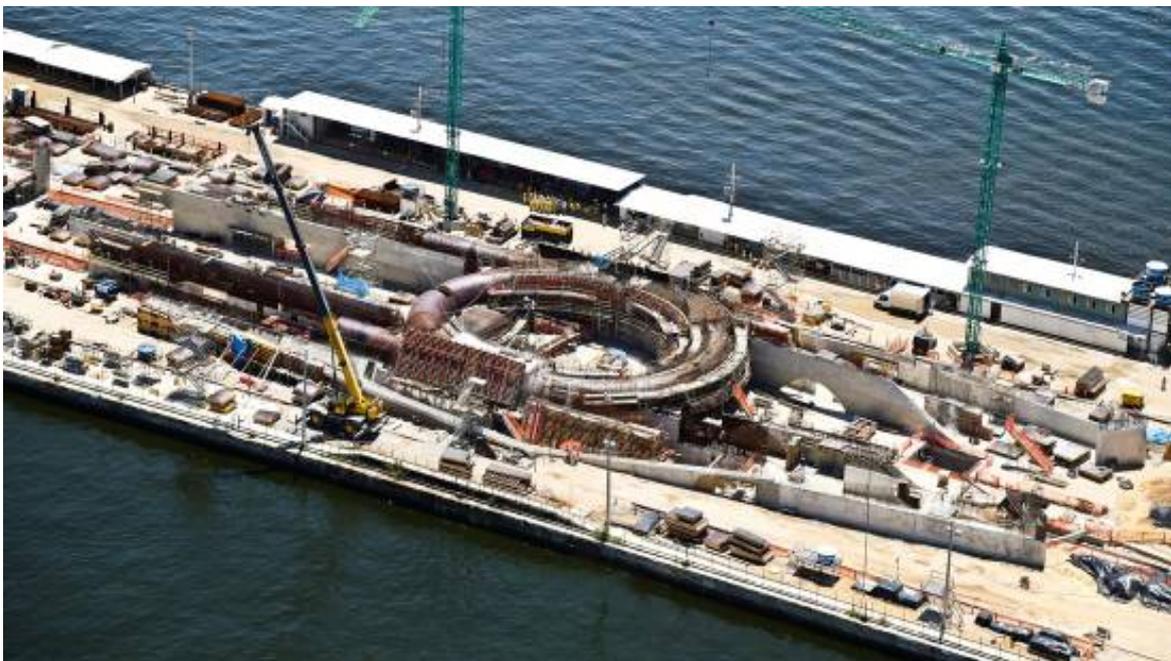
Tunnelsystem im Erdgeschoss (Foto: PERI)
